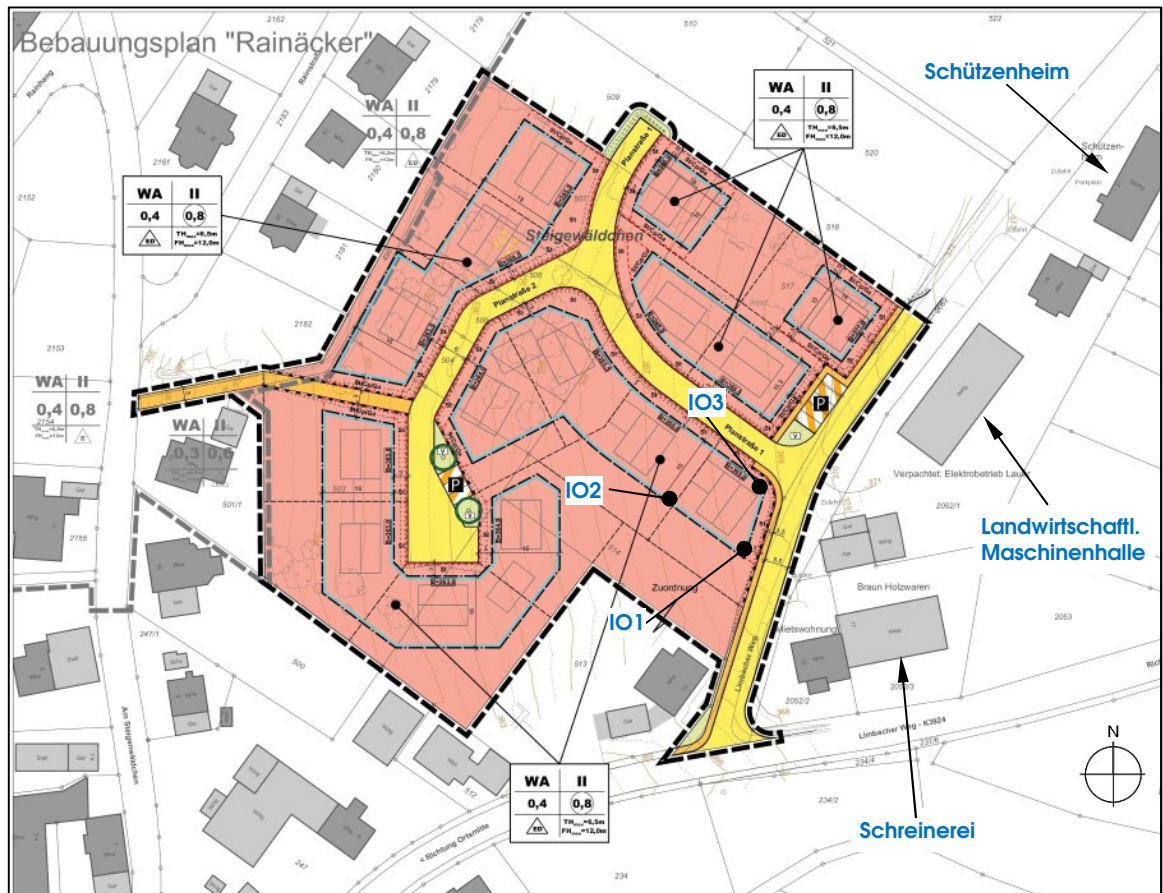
Vorentwurf Bebauungsplan ‚Steigenwäldchen‘ (18)
